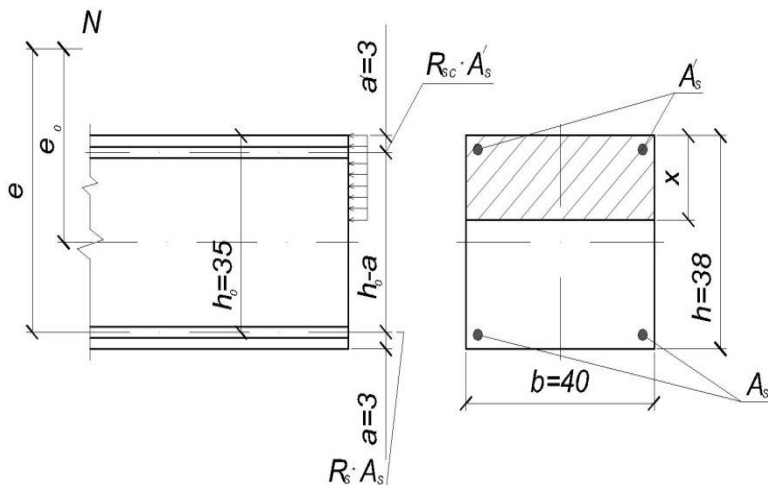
Схема усилий в поперечном прямоугольном сечении внецентренно сжатого элемента.
